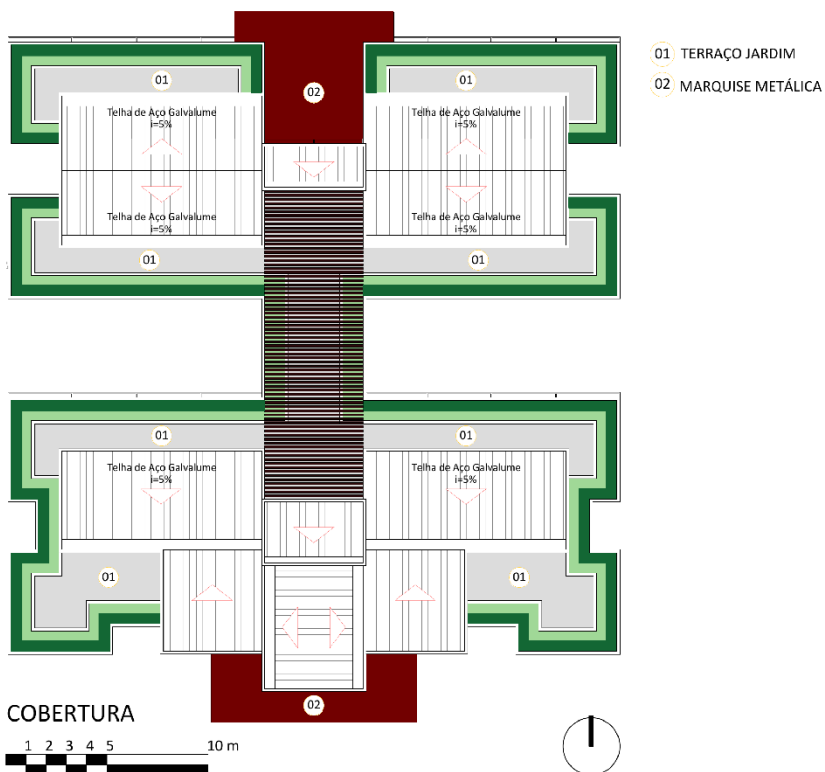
PLANTA COBERTURA DO BLOCO 01. FONTE: AUTORAL.
